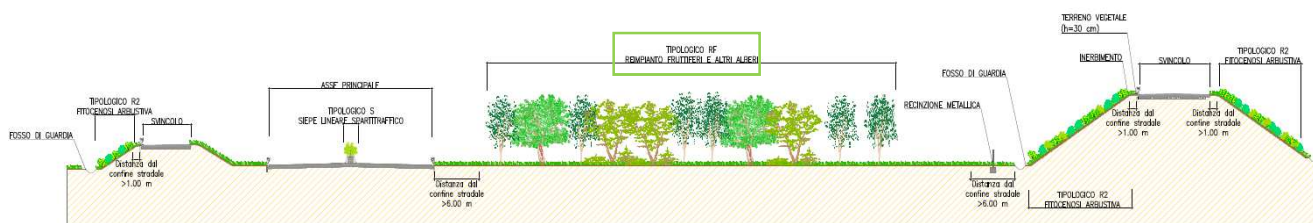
Sezione in corrispondenza dello svincolo SV4 per Santa Cesarea- sistemazione delle opere a verde con evidenza schema di impianto RF
